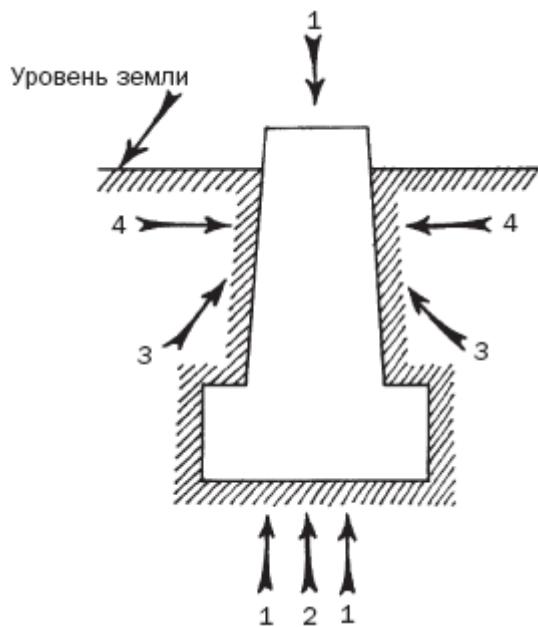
Силы, действующие на фундамент: 1 – сила подземных вод; 2 – сила пучения промерзающего грунта; 3, 4 – силы, действующие по касательной на боковые поверхности фундамента
